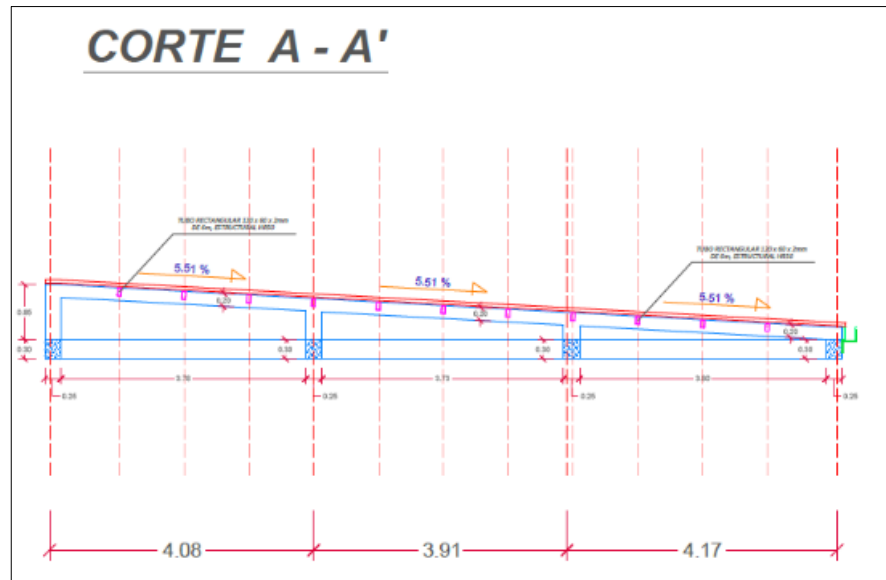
Corte arquitectónico A-A' de la estructura 3 del Centro Vida.
